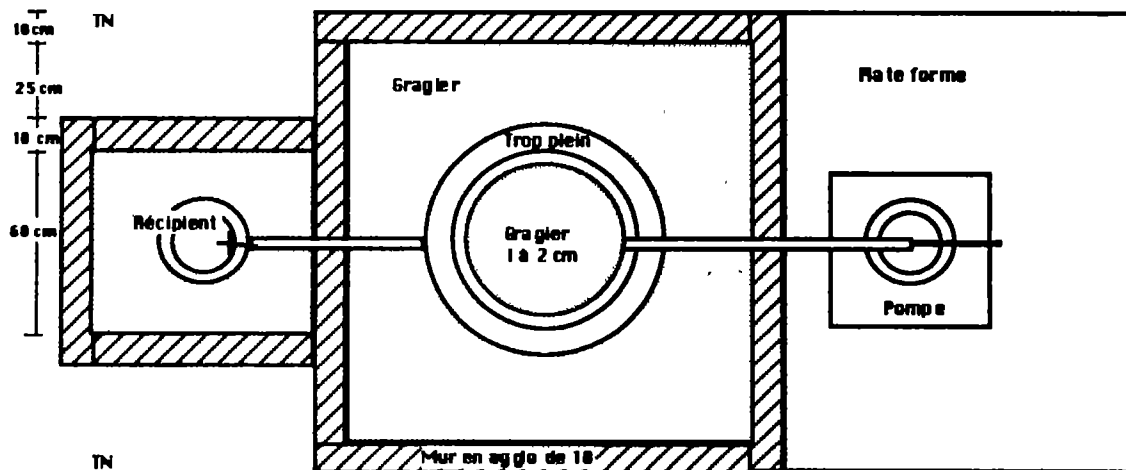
Vue en plan d'un dispositif de déferrisation type "AF" en béton armé
